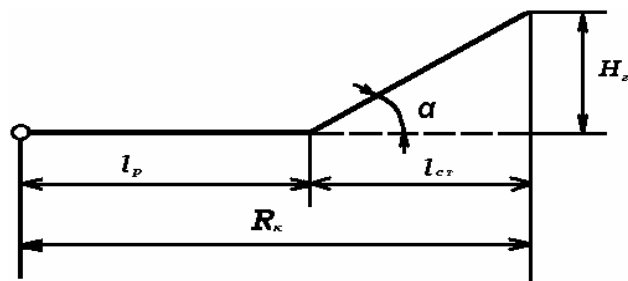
Схема проверки расстановки внутренних пожарных кранов:
